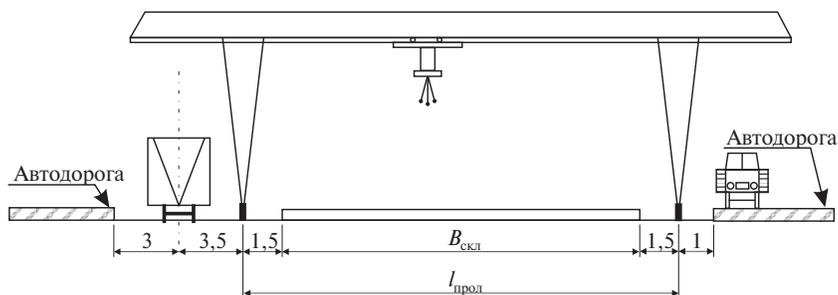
Поперечный разрез типового открытого склада, перекрытого козловым краном с внешним расположением железнодорожного пути и автоподъезда
